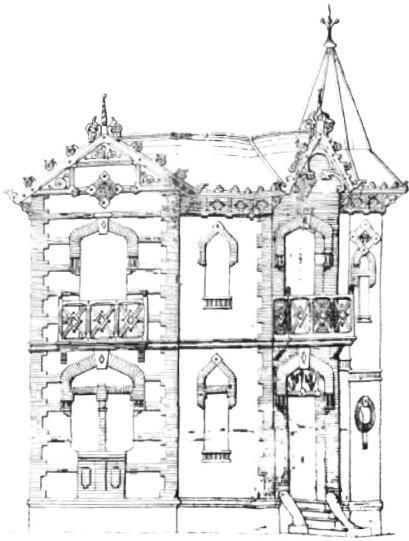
Plano de fachada de la Casa del Guarda. Arquitecto: Francisco Ferriol. Año 1909.
